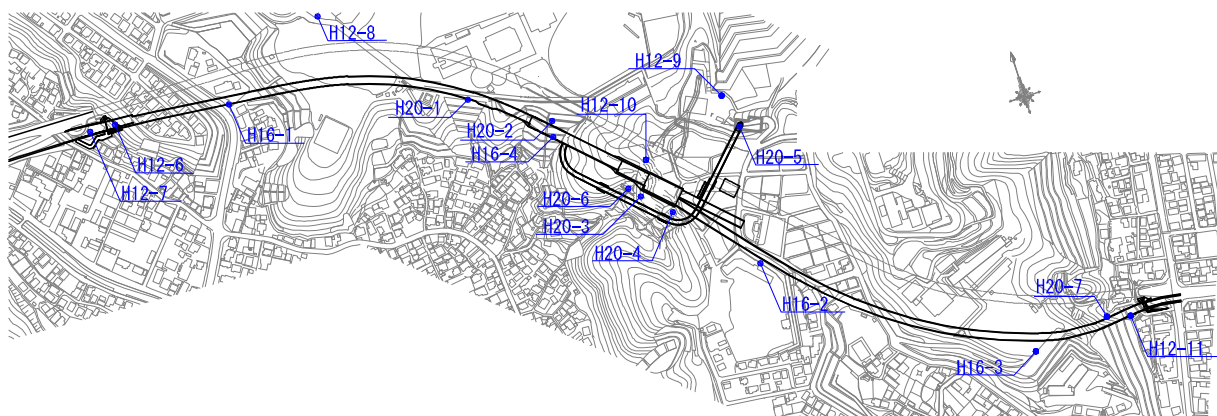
ボーリングによるコア採取および標準貫入試験位置平面図
